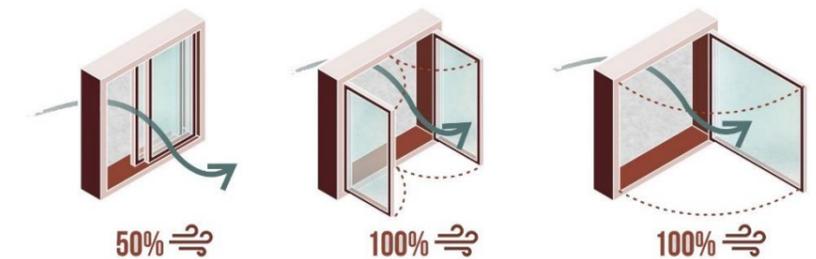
Tipos de aberturas. Adaptado de Plataforma Arquitectura.
